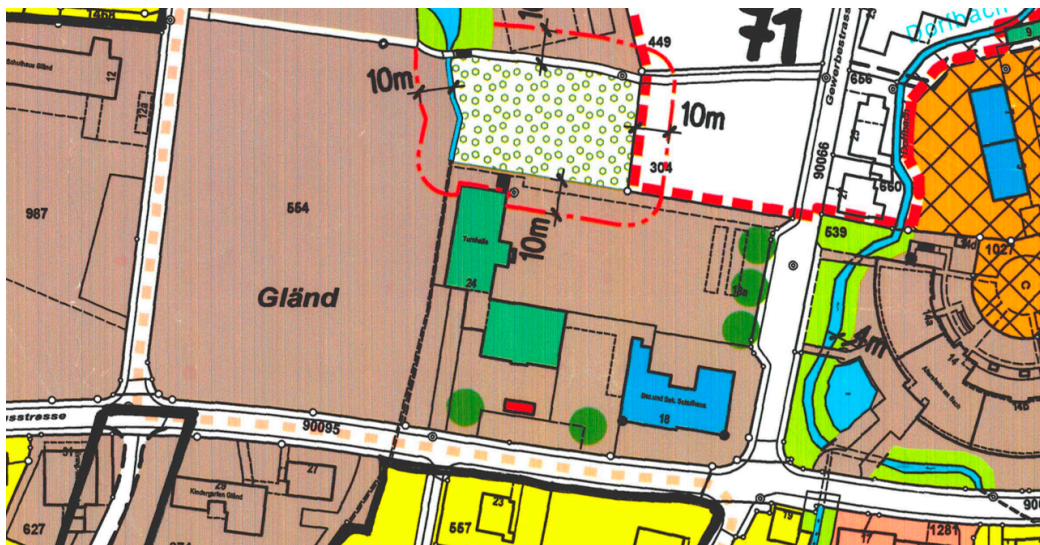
Situationsplan mit Standort der Schulanlage Gländ
